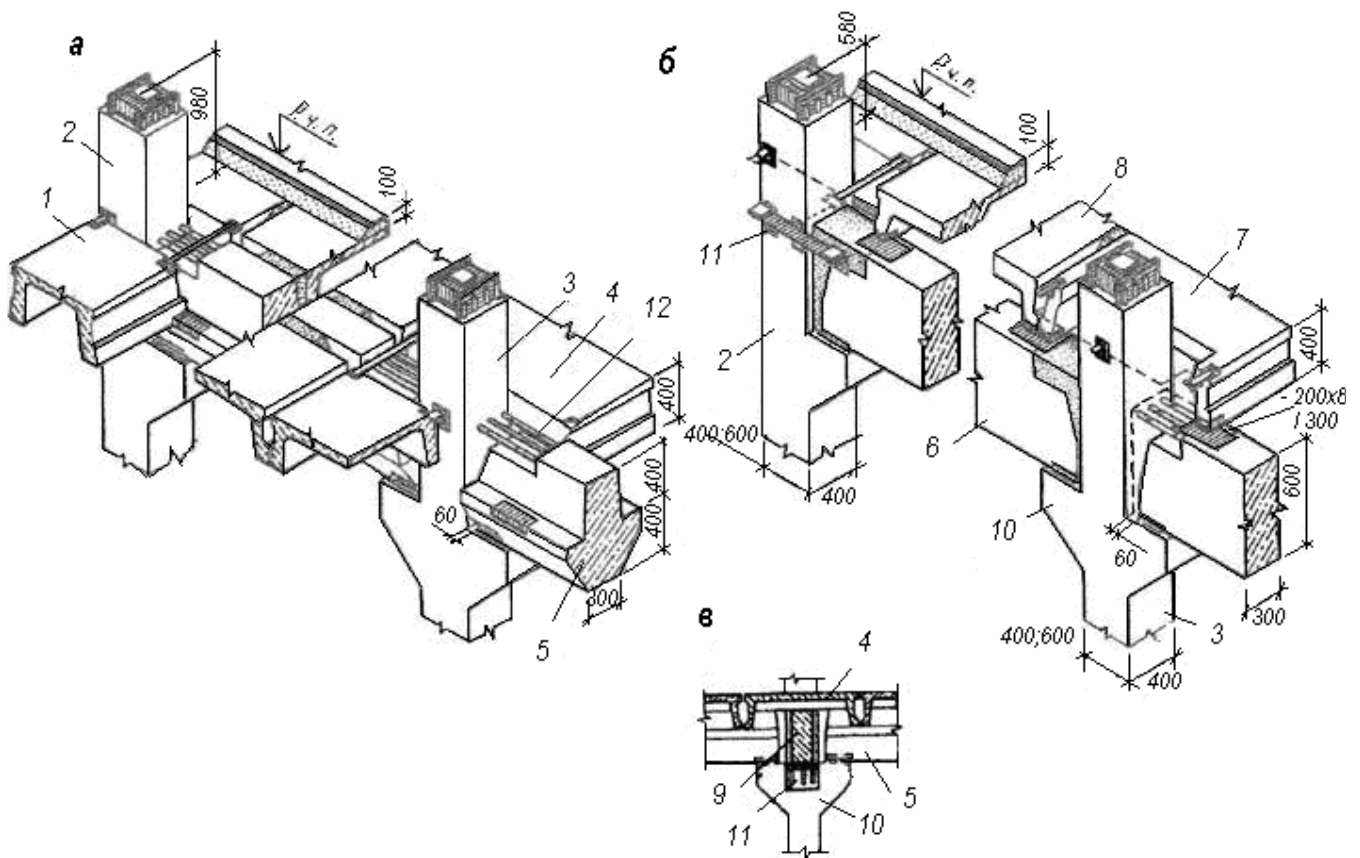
Крайній і середній вузли поперечних рам: а – при обпиранні плит типу 1 на полицки; б – обпиранні плит типу 2 на ригелі зверху; в – обпирання повздовжнього ригеля; 1 – крайня плита розпірка типу 1; 2 – крайня колона; 3 – середня колона; 4 – рядова плита типу 1; 5 – ригель з полицками; 6 – прямокутний ригель; 7 – середня плита розпірка типу 2; 8 – рядова плита типу 2; 9 – повздовжній ригель; 10 – консоль колони; 11 – столик для обпирання плити; 12 – коротиші
